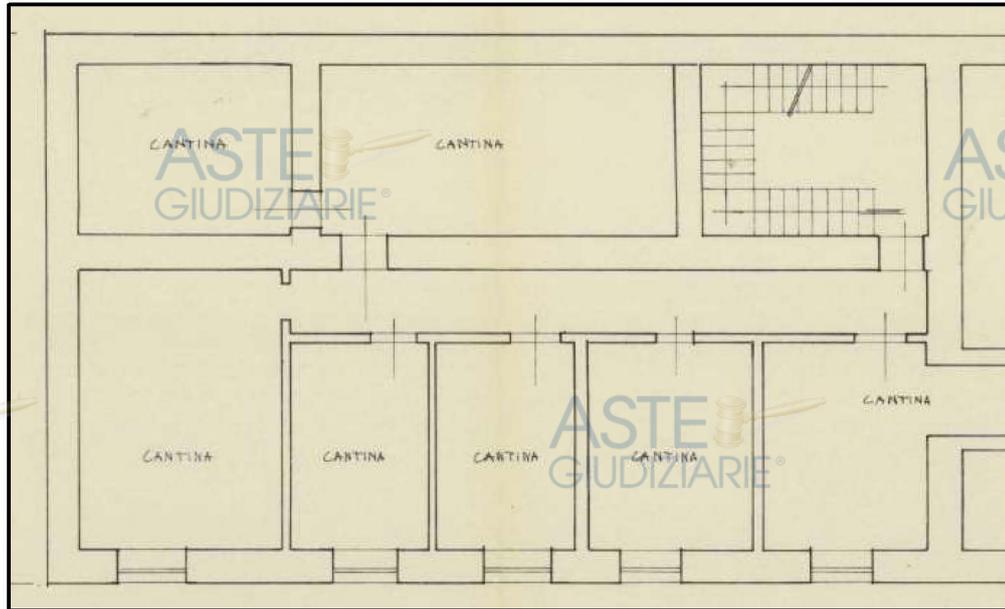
Estratto planimetria piano cantine progetto Licenza edilizia prot. n. prot. 1968 1 30281
